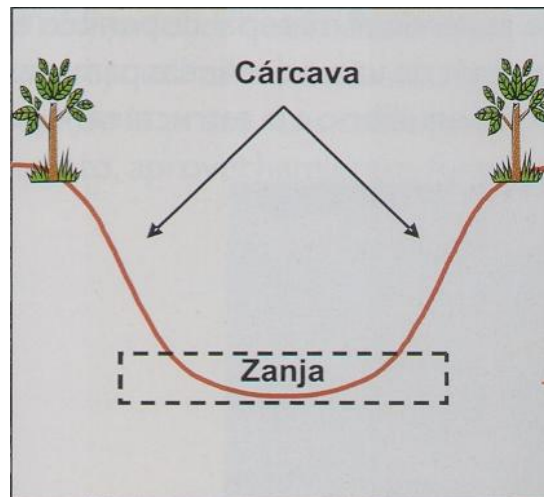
Sección transversal de una cárcava y área de corte para zanja.
